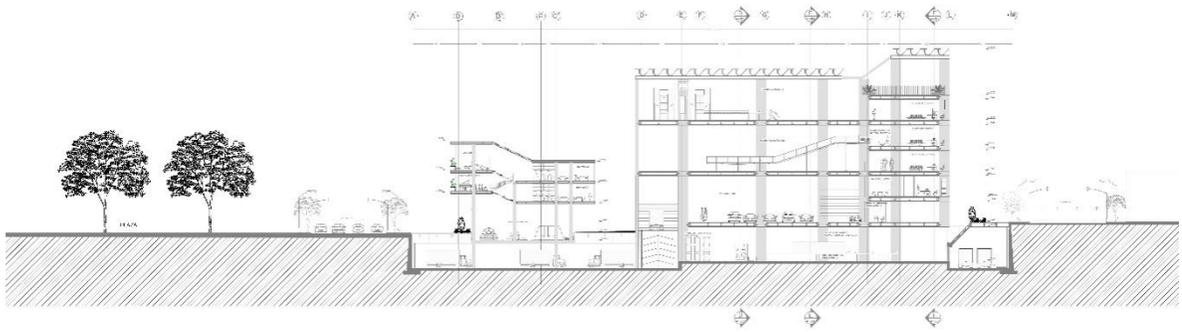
Corte A-A Planta de Reciclaje- Guardería
